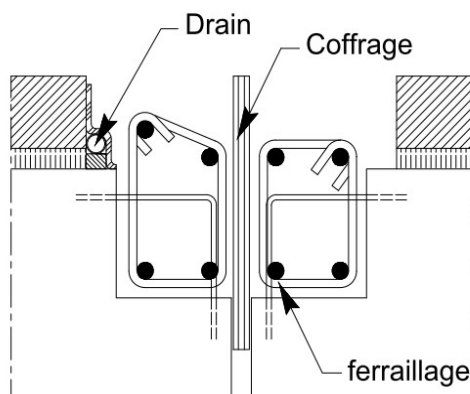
Mise en place du coffrage (par polystyrène expansé ou contreplaqué) et du ferrailage complémentaire
